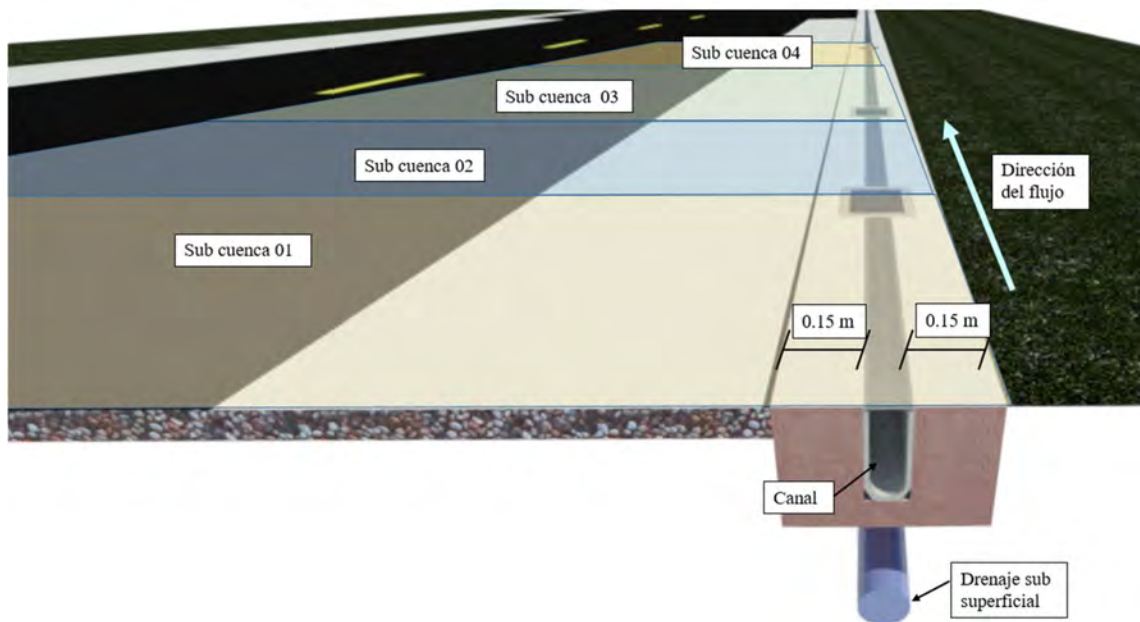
División de áreas de aporte para un lado del área pavimentada.
